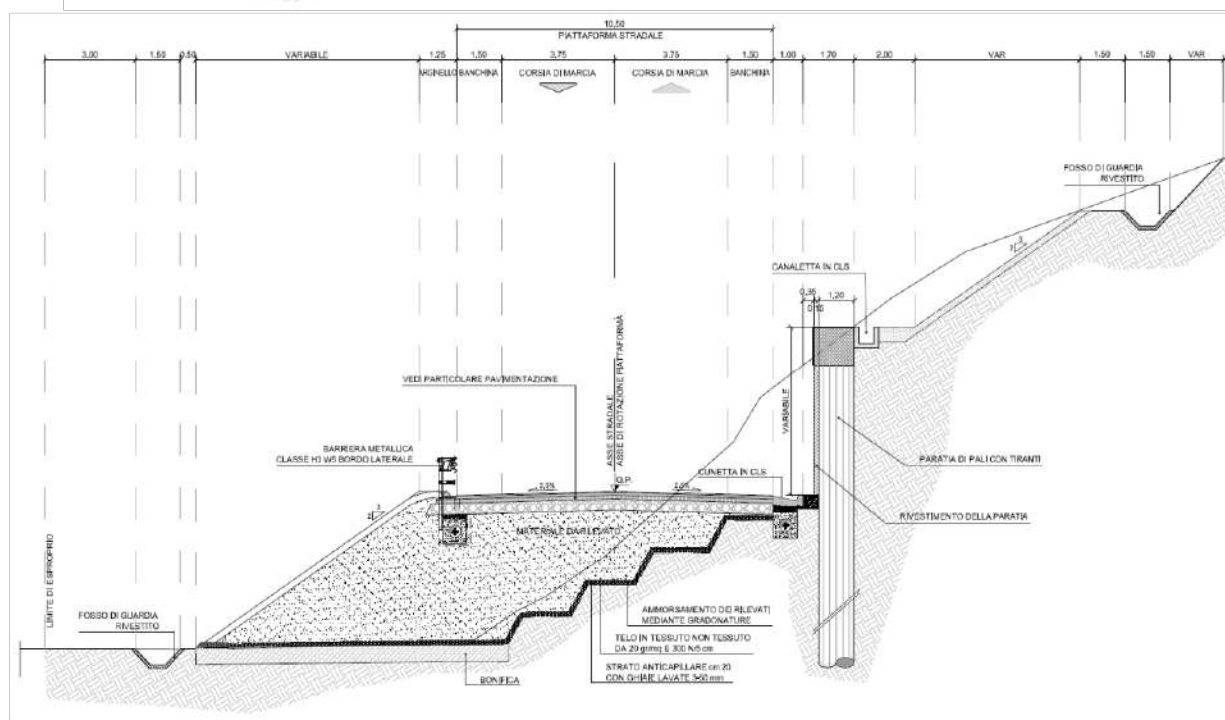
Sezione stradale tipo con interventi di contenimento a monte: paratie
